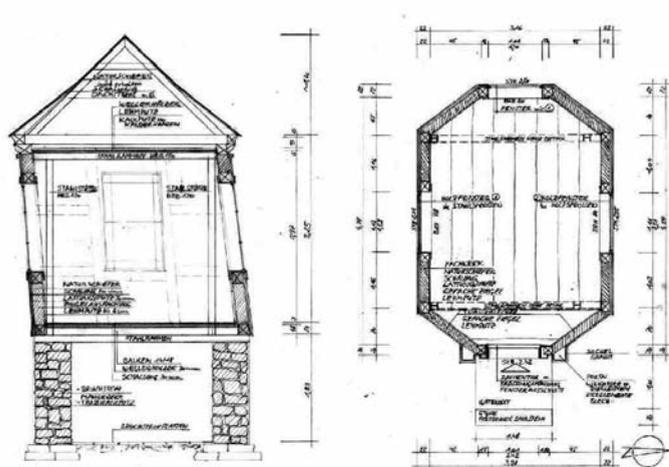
Schnitt und Grundriss Gartenhaus „Twiete“
